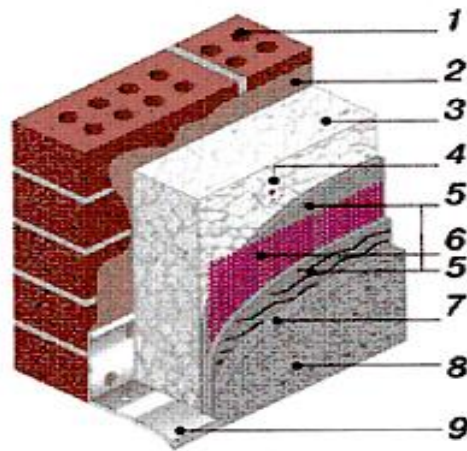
Схема утеплення стін на основі методу скріпленої теплоізоляції: 1 – будівельна основа; 2 – суміш для приклеювання плит; 3 – утеплювач; 4 – кріпінний дюбель; 5 – клеєва суміш; 6 – скловолокняна армуюча пливка; 7 – ґрунтовка; 8 – декоративний шар; 9 – цокольний профіль
